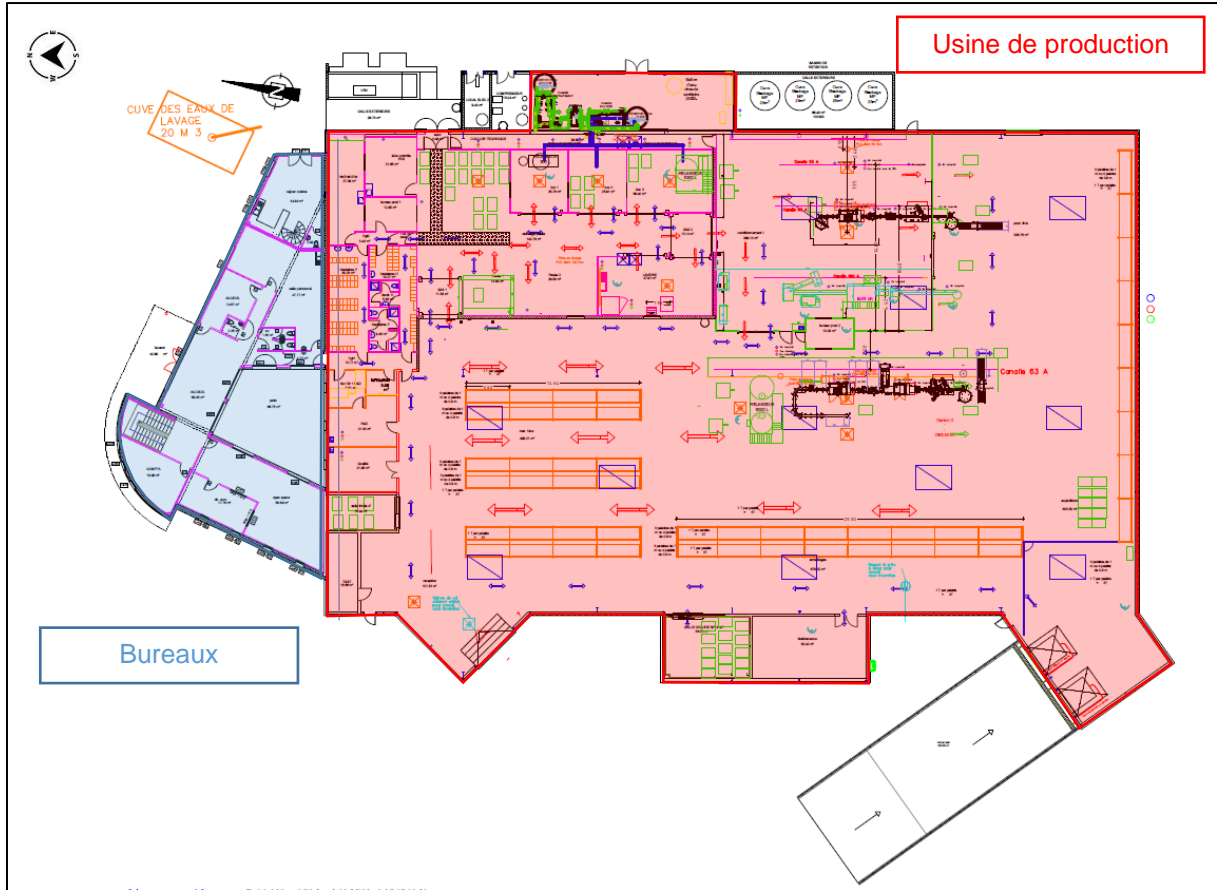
Découpage de l'usine en plan RDC – échelle 1/100
